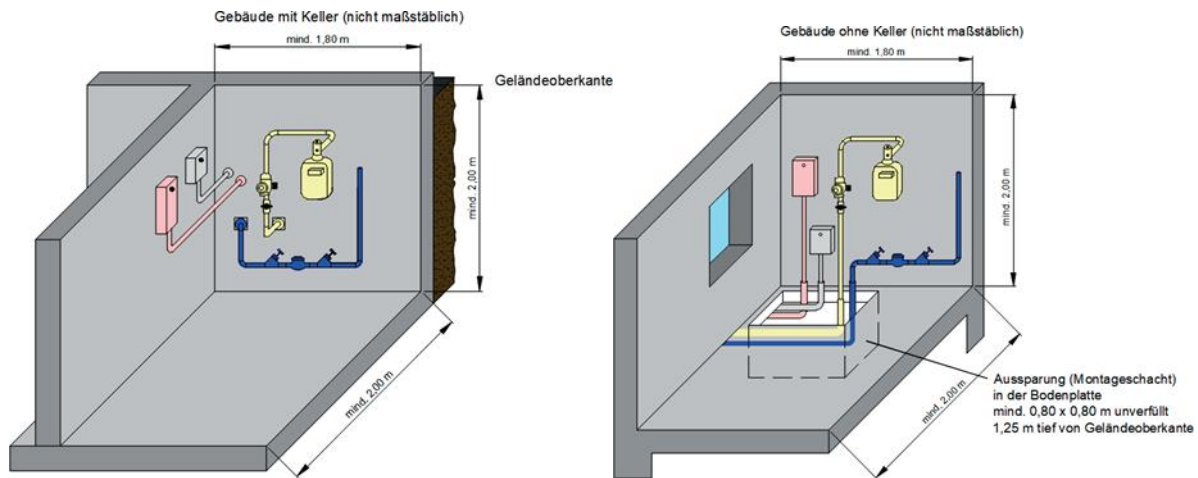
Anschlussraum - Gebäude mit Keller (Wasser)
